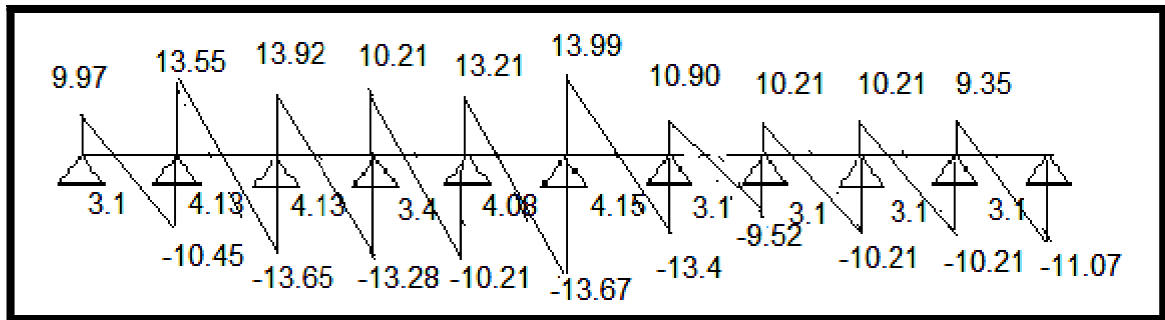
Diagramme des efforts tranchants à l'ELU des poutrelles du plancher Plancher terrasse (type 1)
